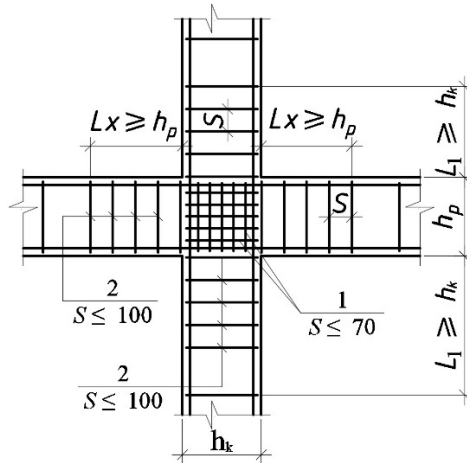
Армирование монолитного рамного узла: 1 – армирование центральной зоны узла хомутами и дополнительными вертикальными стержнями; 2 – армирование поперечной арматурой участков колонн и ригелей, примыкающих к узлу
